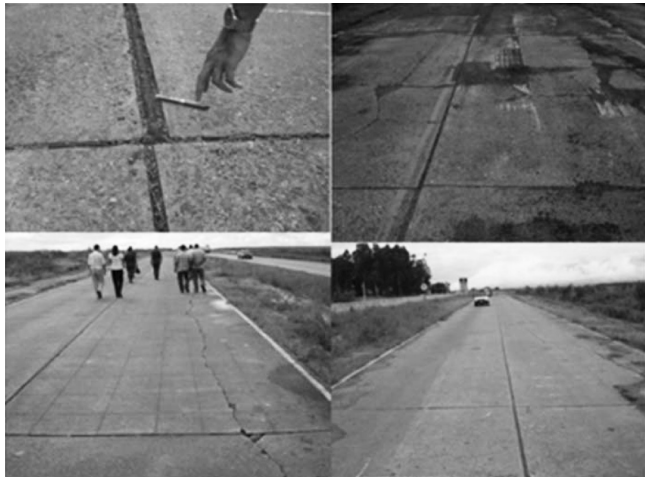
Estado do pavimento rígido da BR-101/PE.
